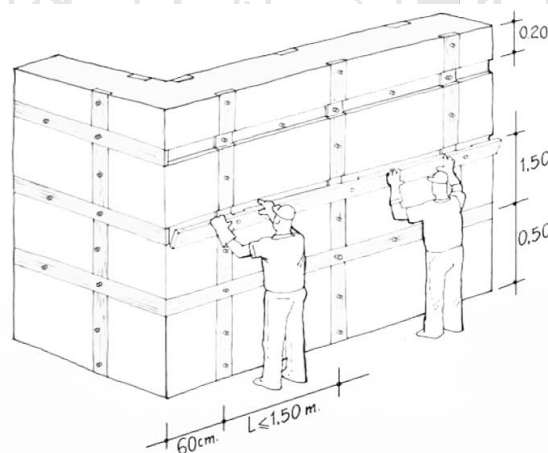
Detalle de elementos de madera confinante (*PADT-REFORT, 1984*).
